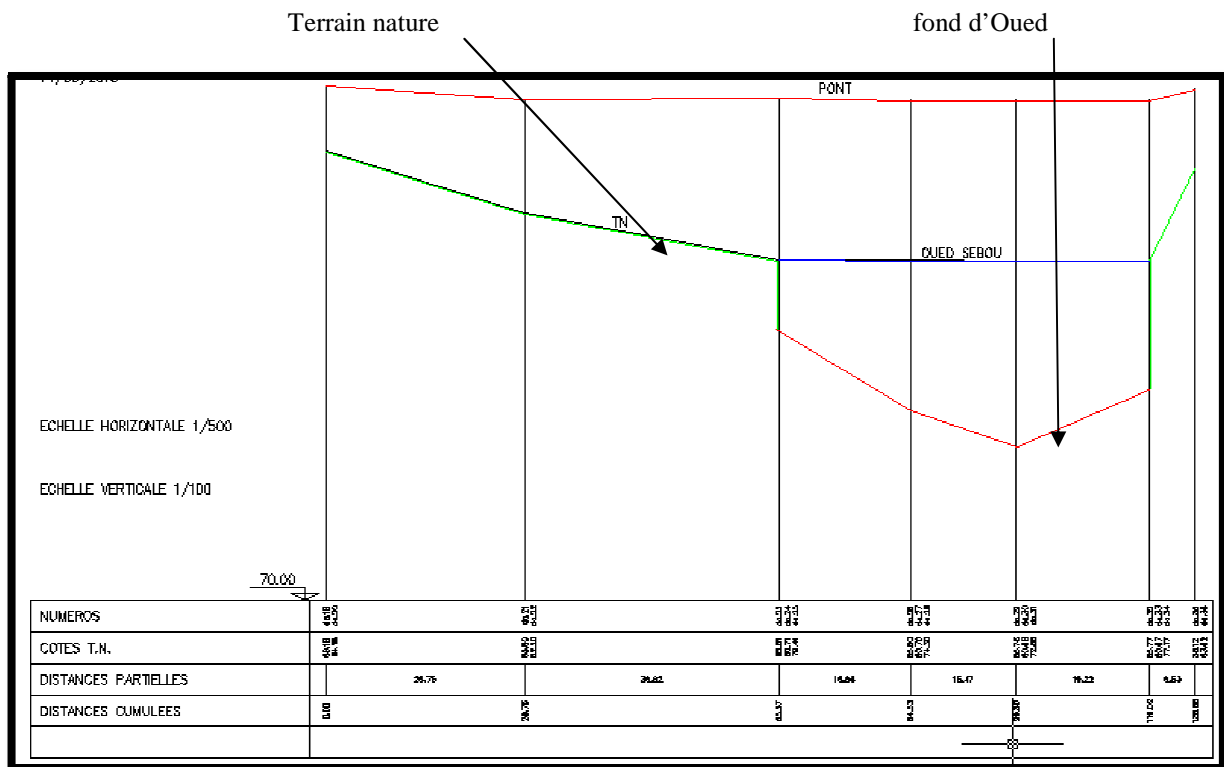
Le profil en travers de la coupe 2 d'Oued Sebou
